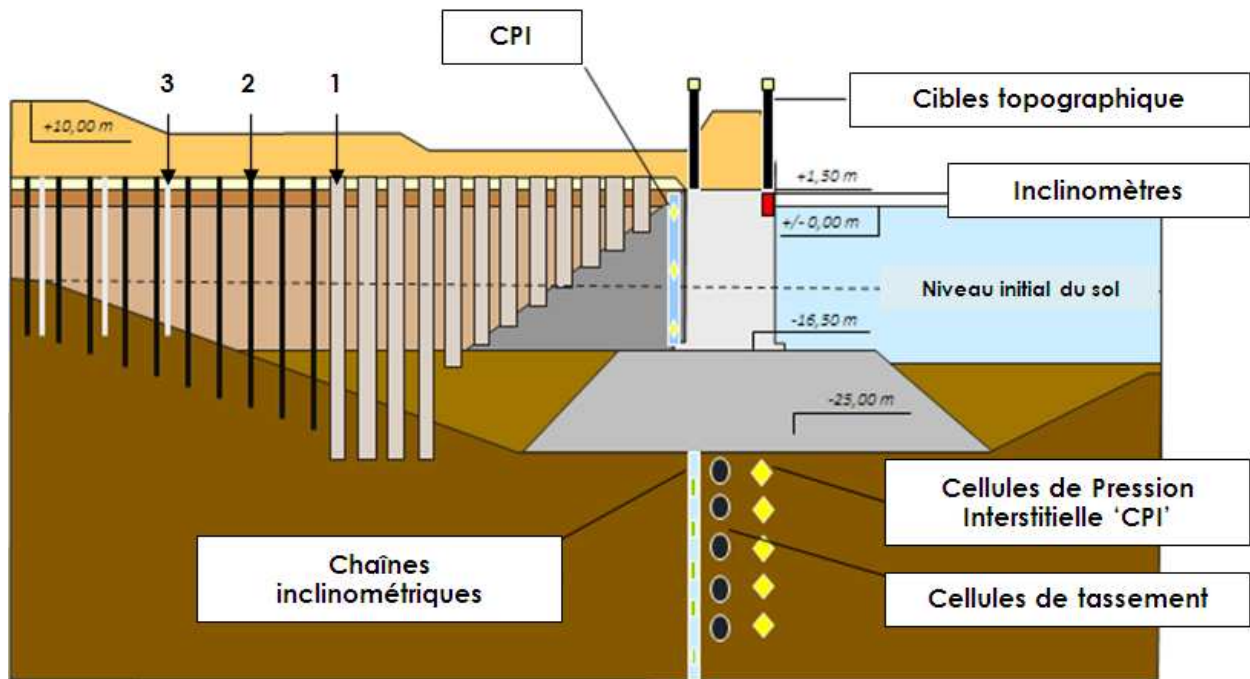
Section d'instrumentation (1 – Colonnes ballastées / 2 – Drains verticaux / 3 – Pieux préfabriqués)
